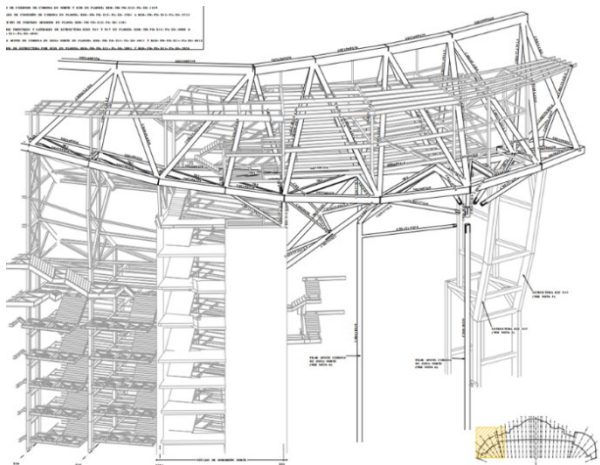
Modelo IFC: Vista de núcleo de hormigón Norte
